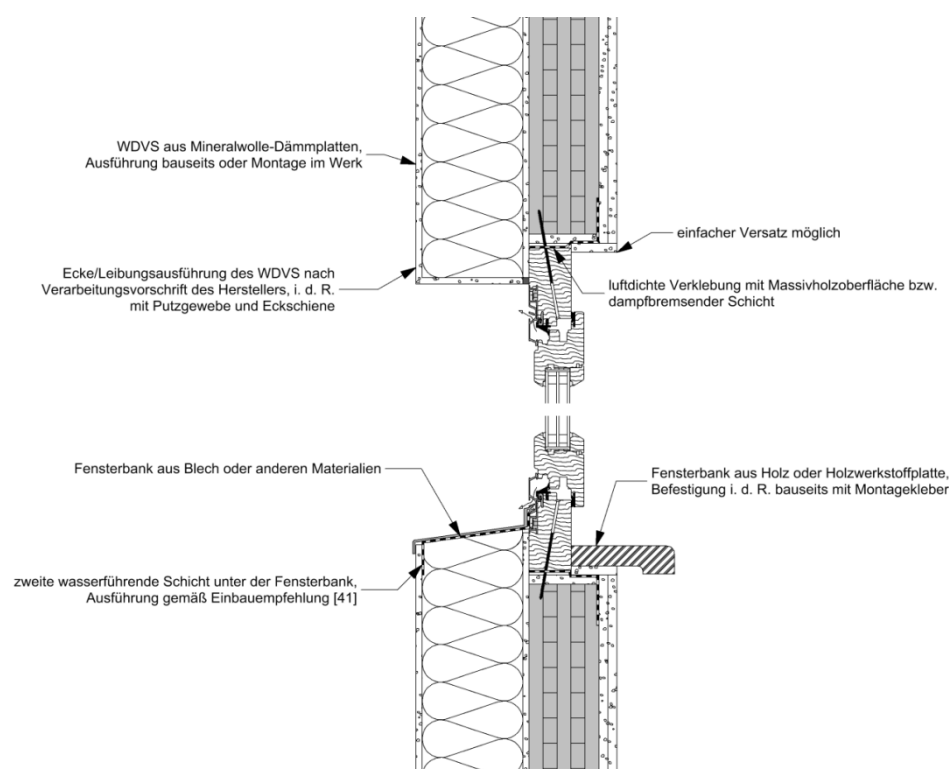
Einbau von Fenstern mit Holzrahmen in Außenwände in Brettsper Holzbauweise mit WDVS-Fassade. Wichtig ist insbesondere der luftdichte Anschluss des Fensters an die flächige luftdichte Ebene.
